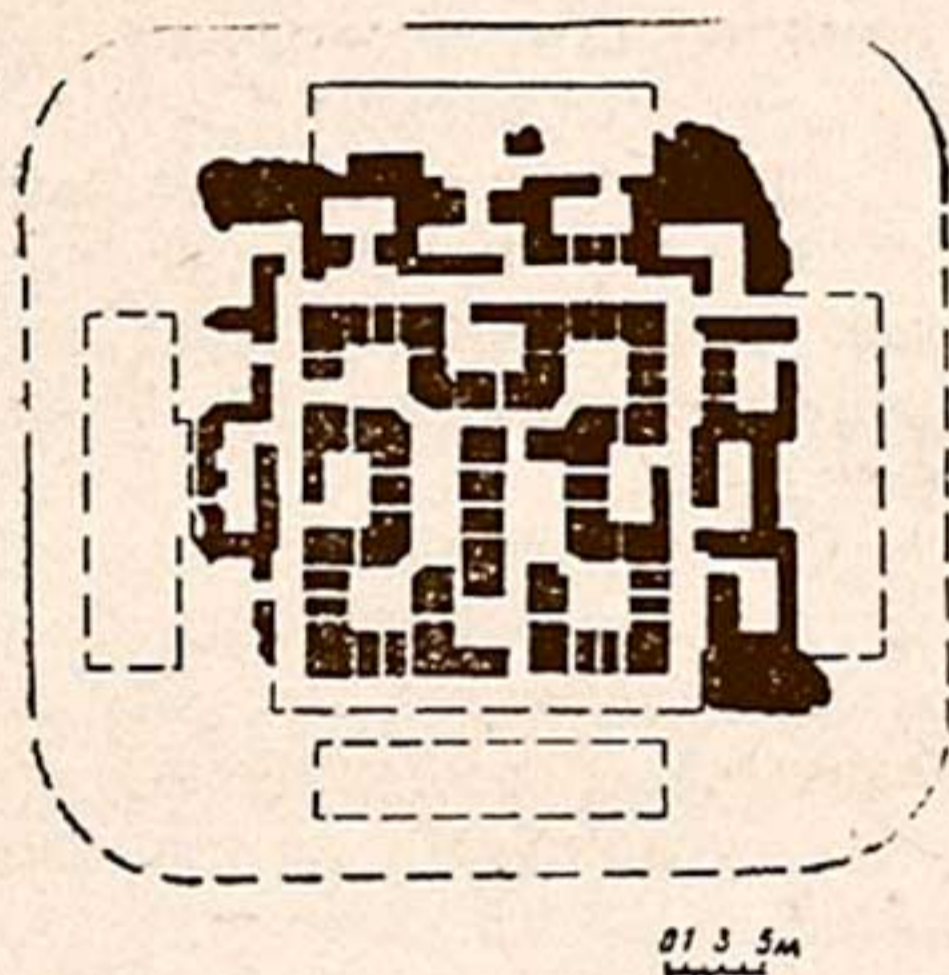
План раскопанного здания по 1-му этажу (Обмер Г. В. Шишкиной.)
